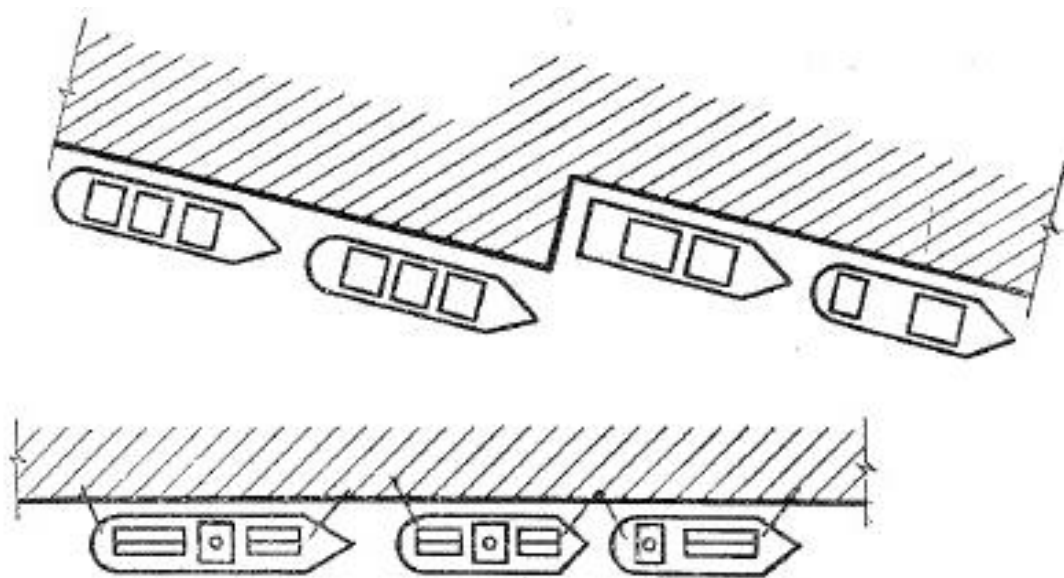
Швартовка судов к причальному сооружению в виде набережной
